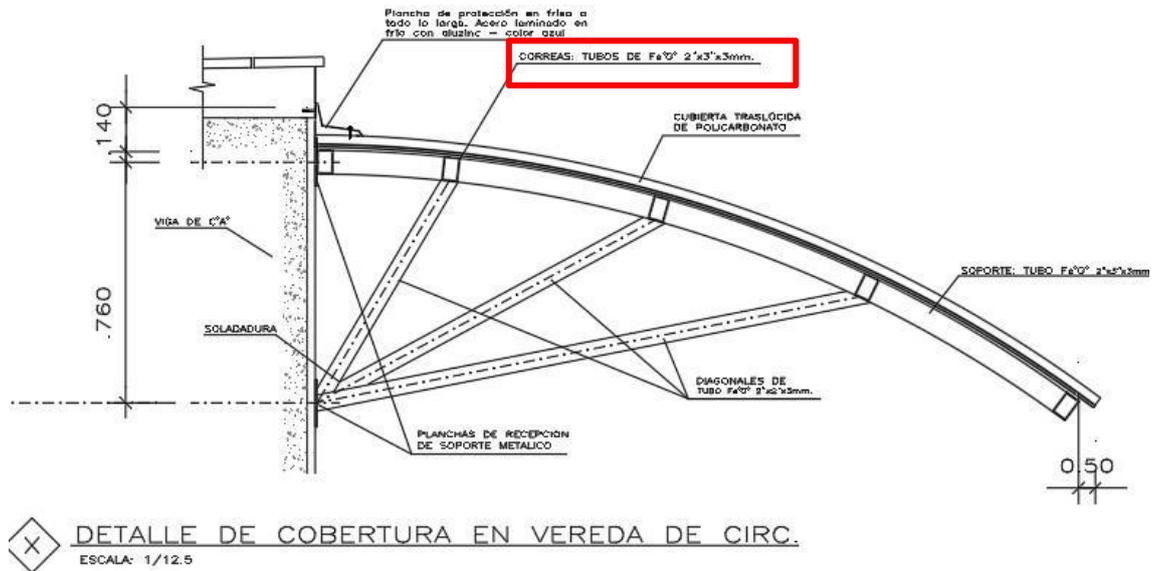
Detalle de cobertura en vereda de circ, del plano D-21
